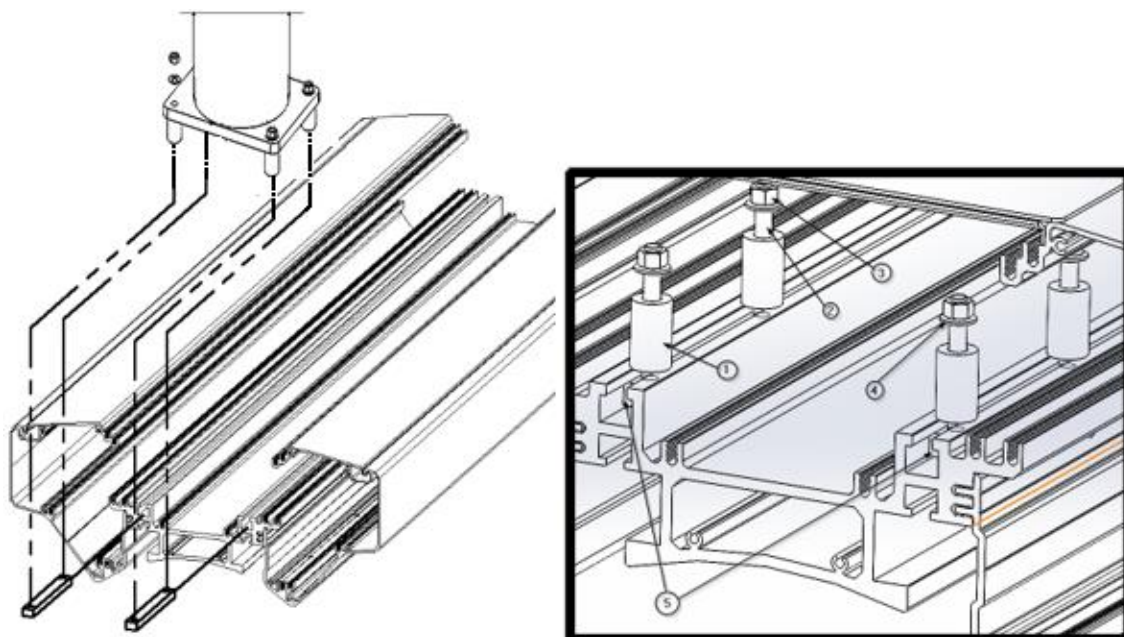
Schéma d'ancrage d'une section du corps principal d'ABITUS sur une descente de gouttière
